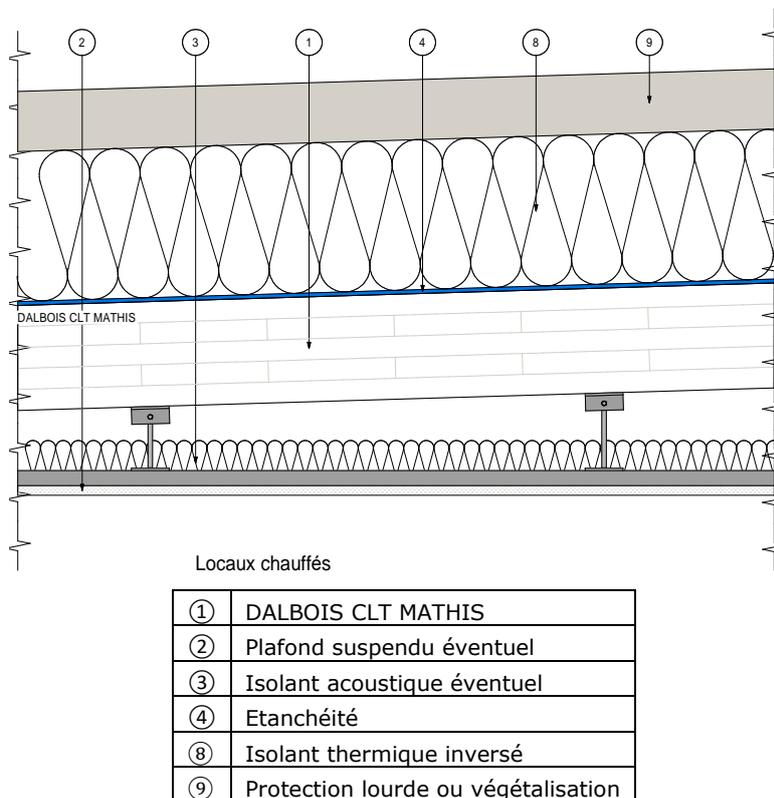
Utilisation d'un CLT DALBOIS CLT-M en configuration de toiture isolée sur bâtiment chauffé– Toiture inaccessible, technique et végétalisée – Isolation inversée
